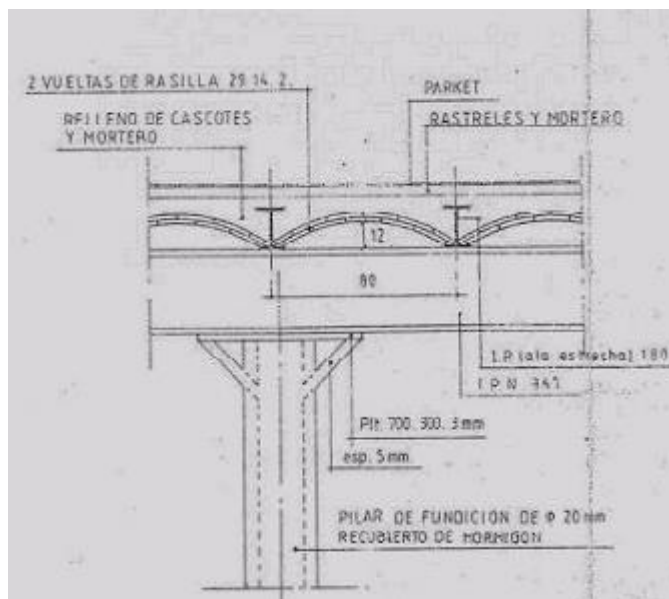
Detalle del forjado de vigueta metálica y bovedilla cerámica tomado de los planos arquitectónicos originales del edificio de 6 niveles
